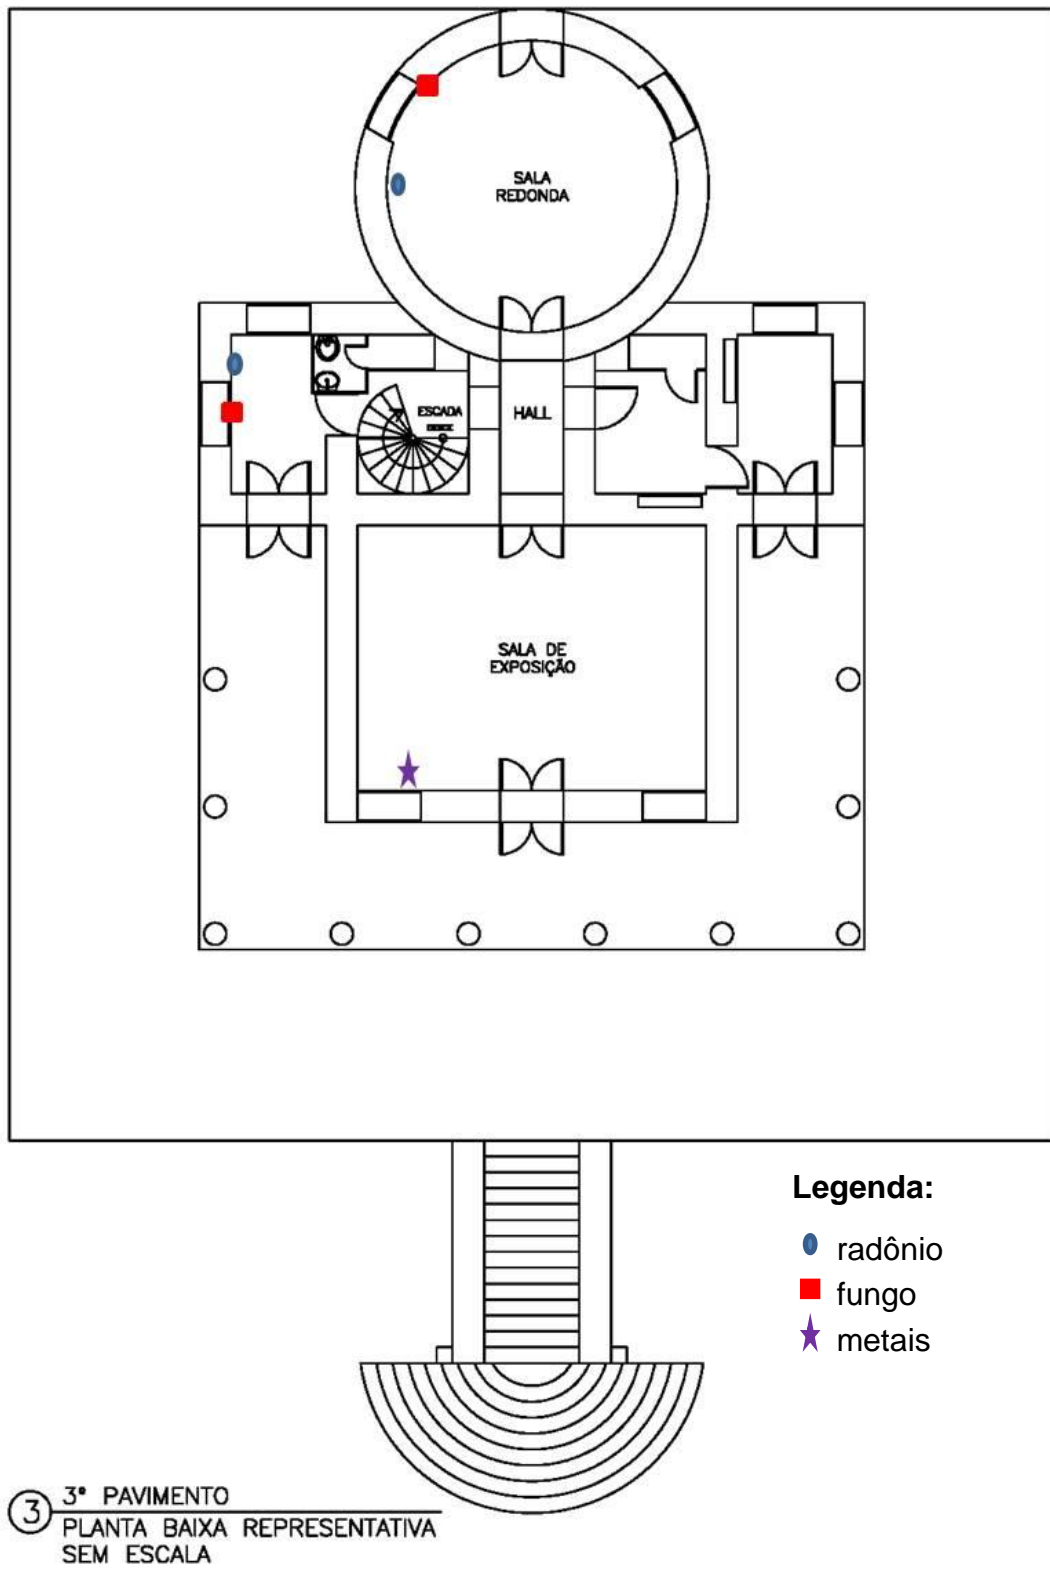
Planta baixa, Prédio A, terceiro pavimento.
